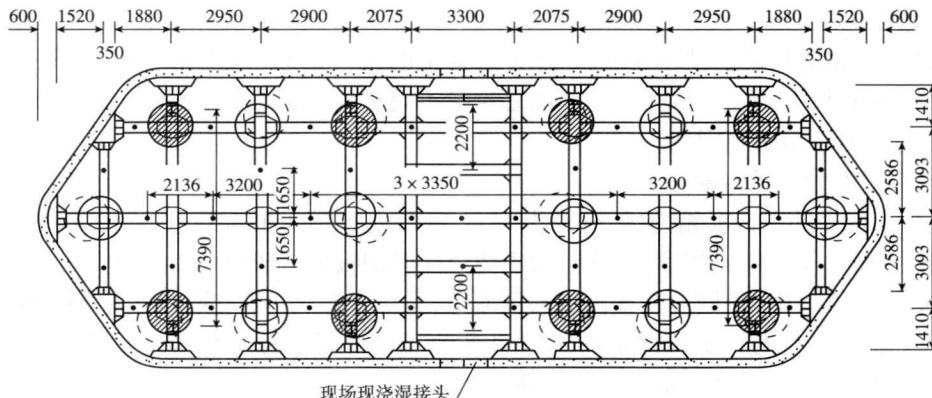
钢扁担梁尺寸(尺寸单位:mm)
